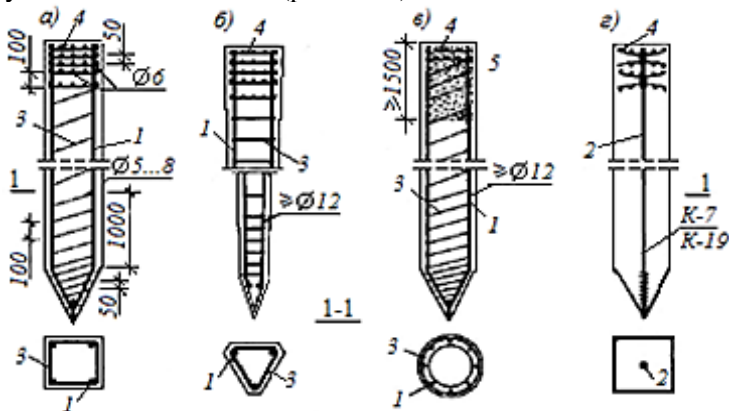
Армування забивних палі: *a, б* – суцільні з ненапруженою арматурою; *в* – порожниста з ненапруженою арматурою; *г* – суцільна з напруженою арматурою; *1* – поздовжня ненапружена арматура; *2* – те ж, що напружується; *3* – поперечна арматура; *4* – сітки; *5* – фібробетон
